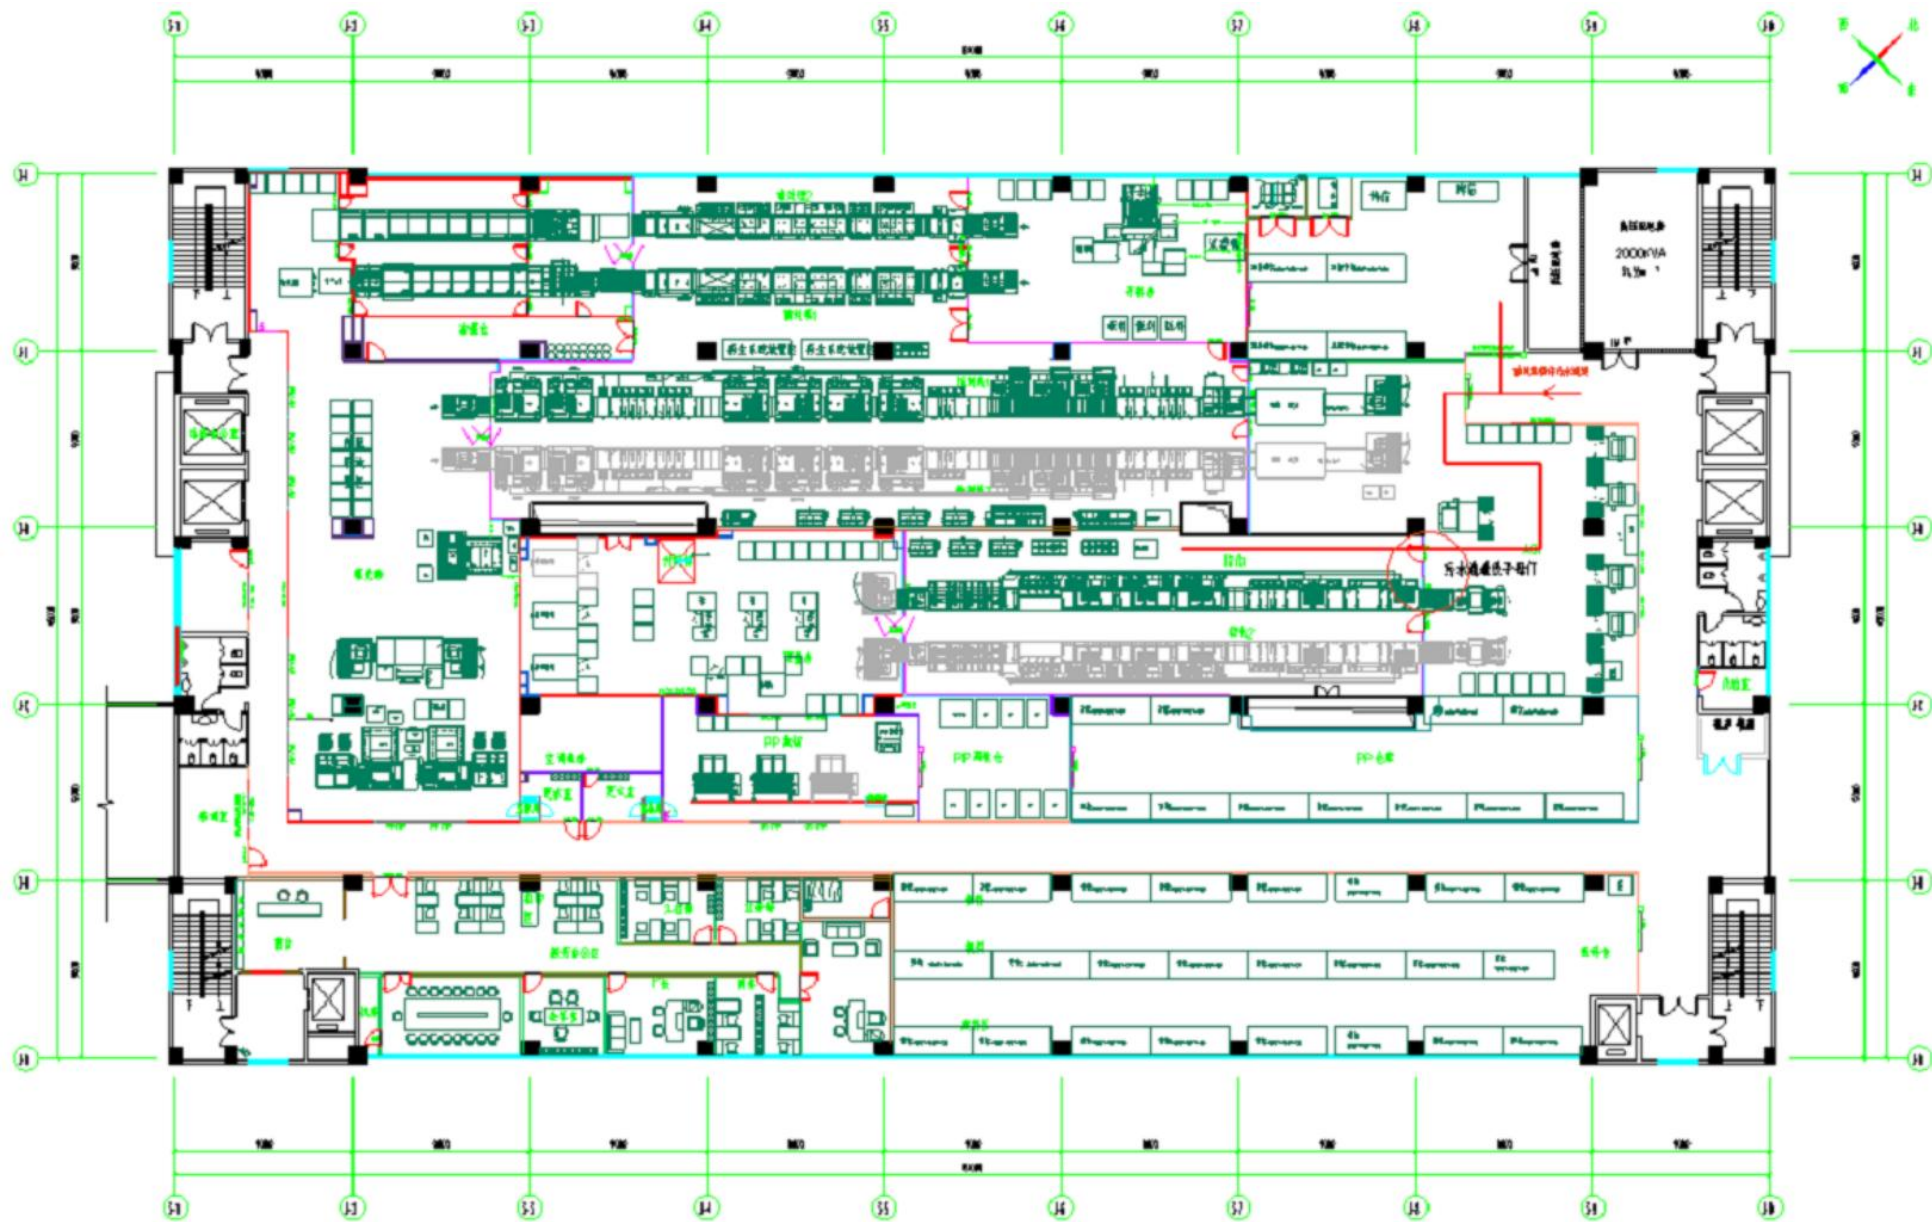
本项目三号厂房 2 楼实际平面布置图
